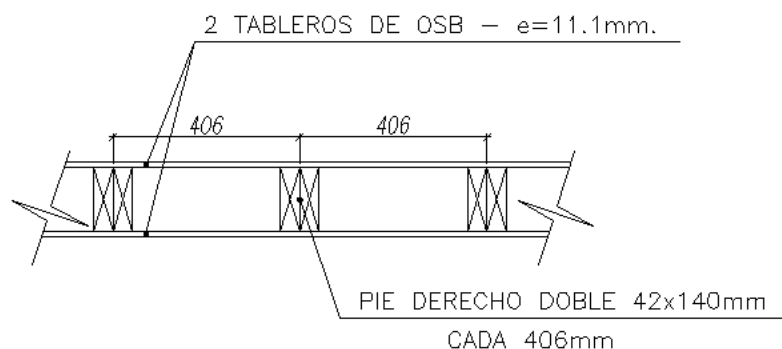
Esquema de Escantillón de paneles de muros longitudinales y transversales en primer piso (solo revestimiento estructural - unidades en milímetros).
